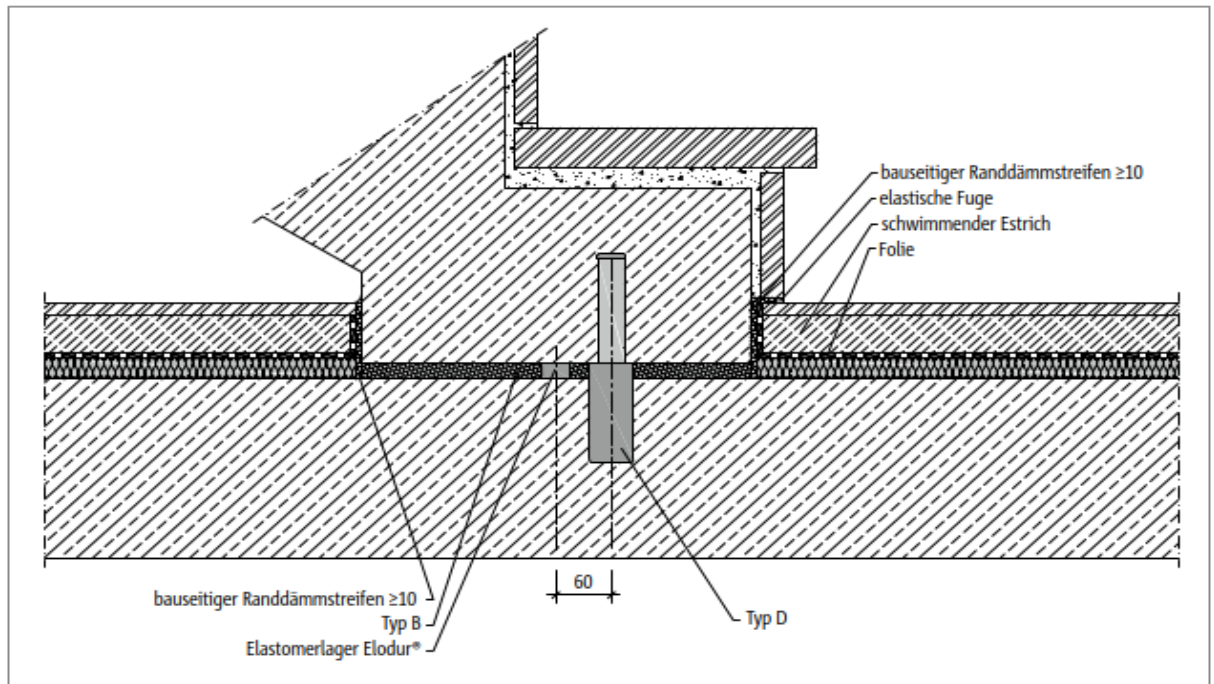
Schöck Tronsole® Typ B + Typ D: Alternative Installation
